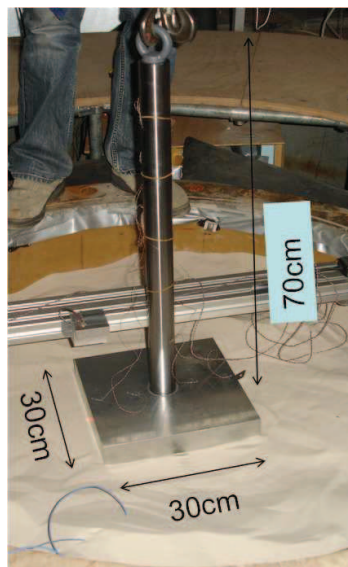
Photo du modèle de la fondation avec le poteau encastré
